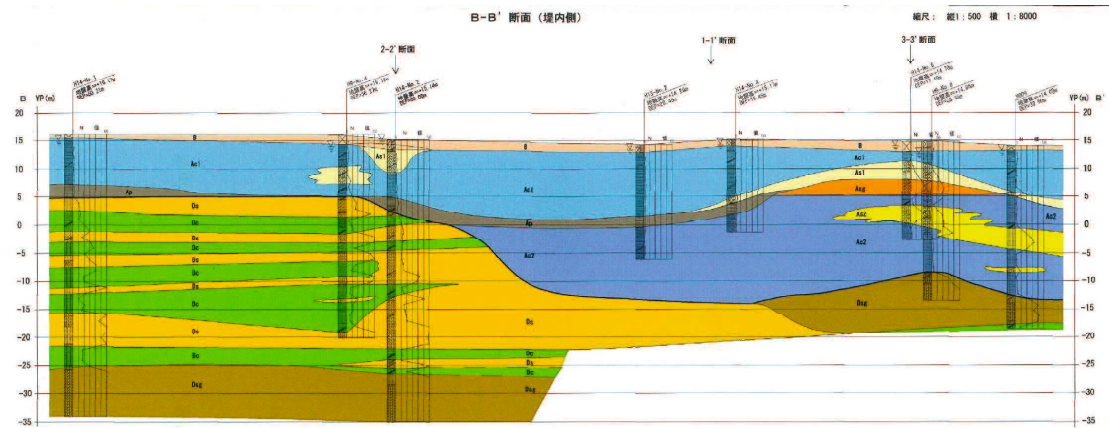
B-B'断面の基礎地盤土質縦断図
